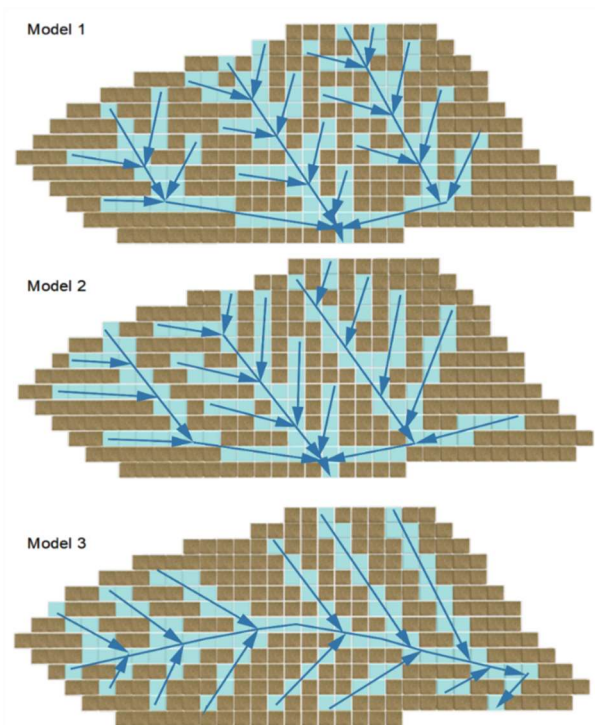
Variações dos desenhos do sistema de drenagem (sem escala): 1) planta com arranjo ramificado a; 2) planta com arranjo ramificado b e 3) planta com arranjo espinha de peixe.
